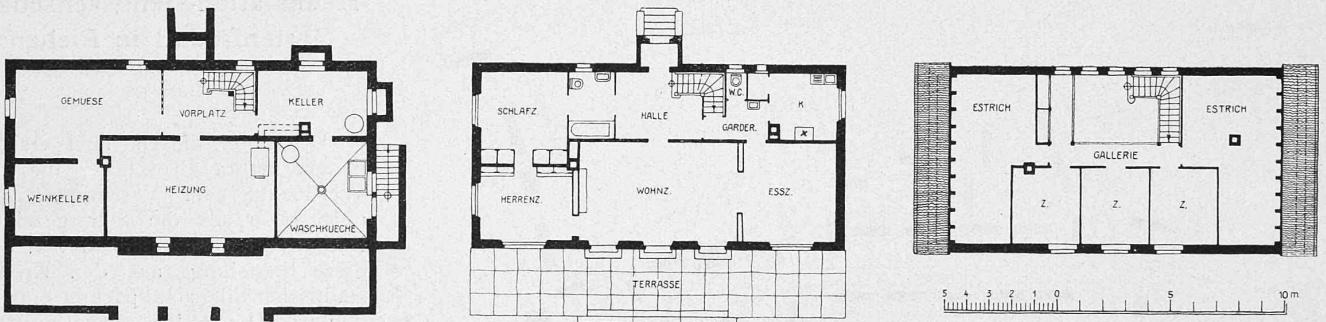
bis 7. Grundrisse vom Hause R. — Masstab 1 : 300.
